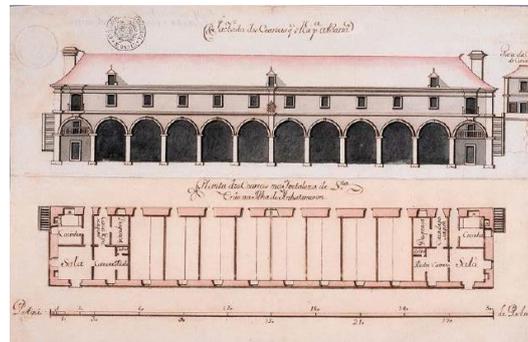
Iconografia de 1747 com planta e fachada principal, lado nordeste da construção (20).
